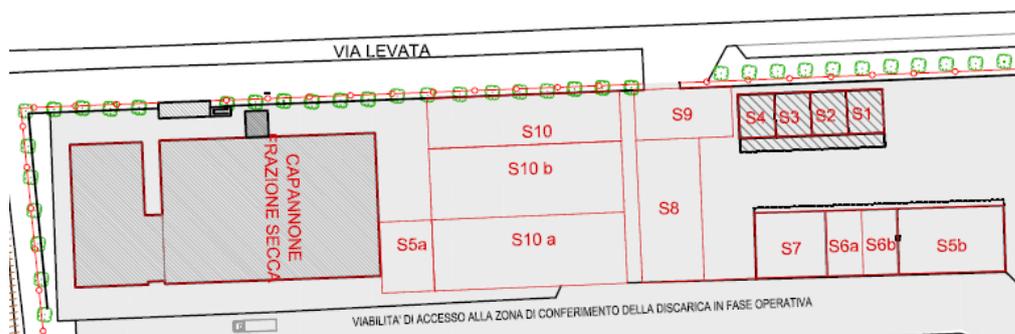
Dettaglio planimetria generale: l'impianto di recupero
